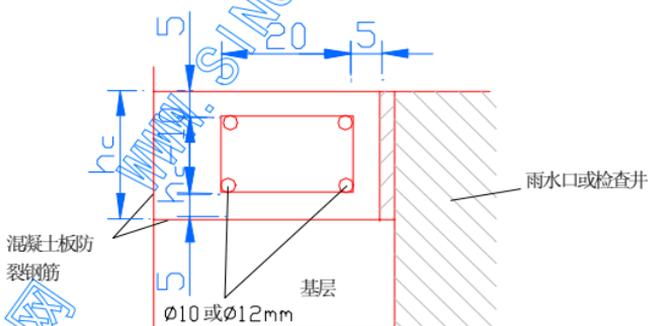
混凝土板中雨水口和检查井周围防裂钢筋的布置
